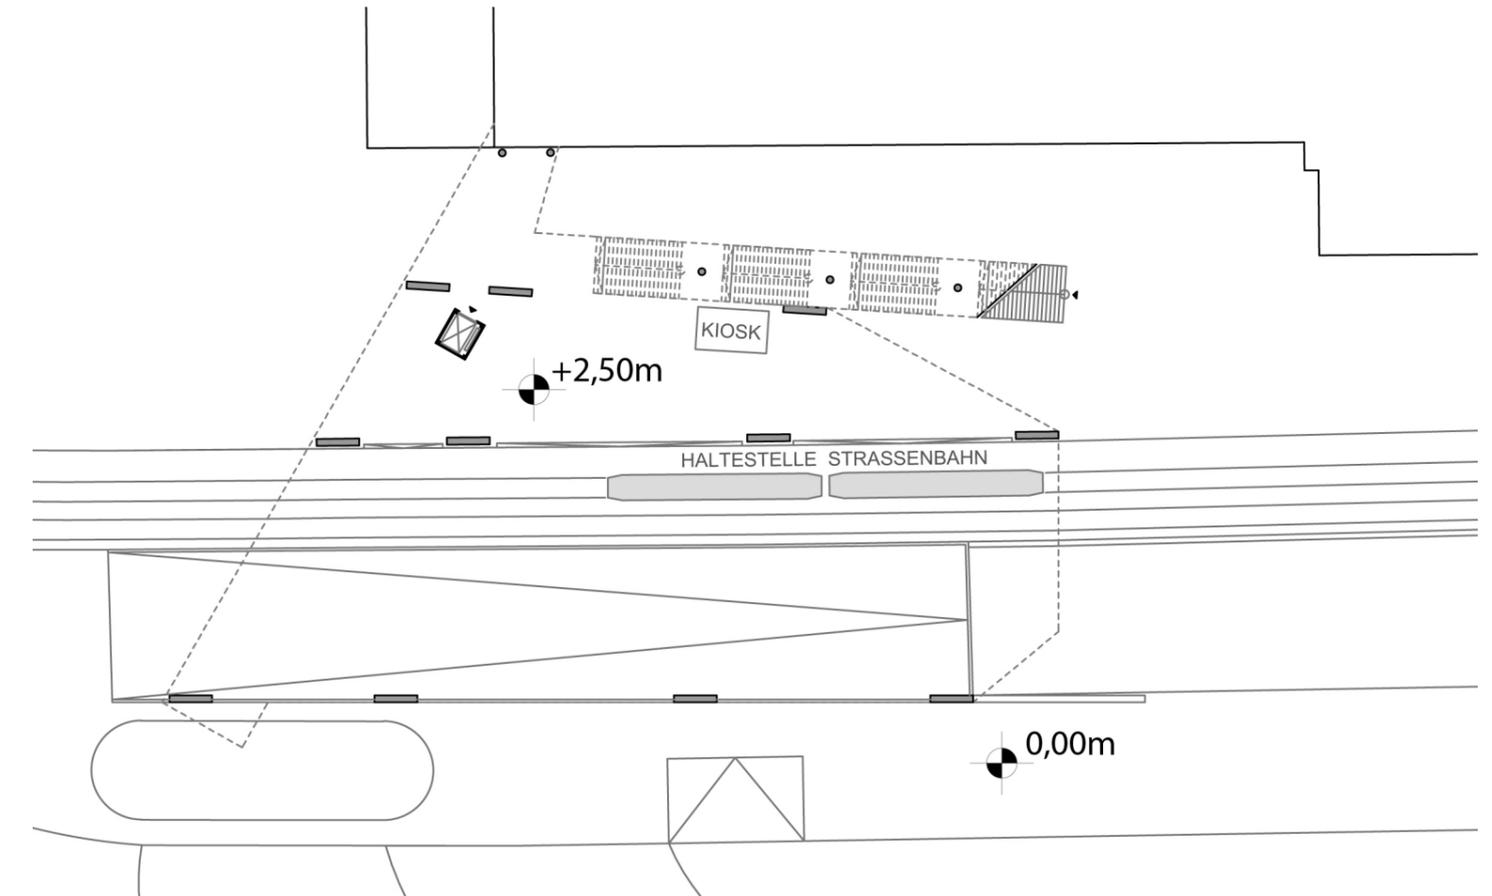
Grundriss neues Konzerthaus, Erdgeschoss, M: 1:500
